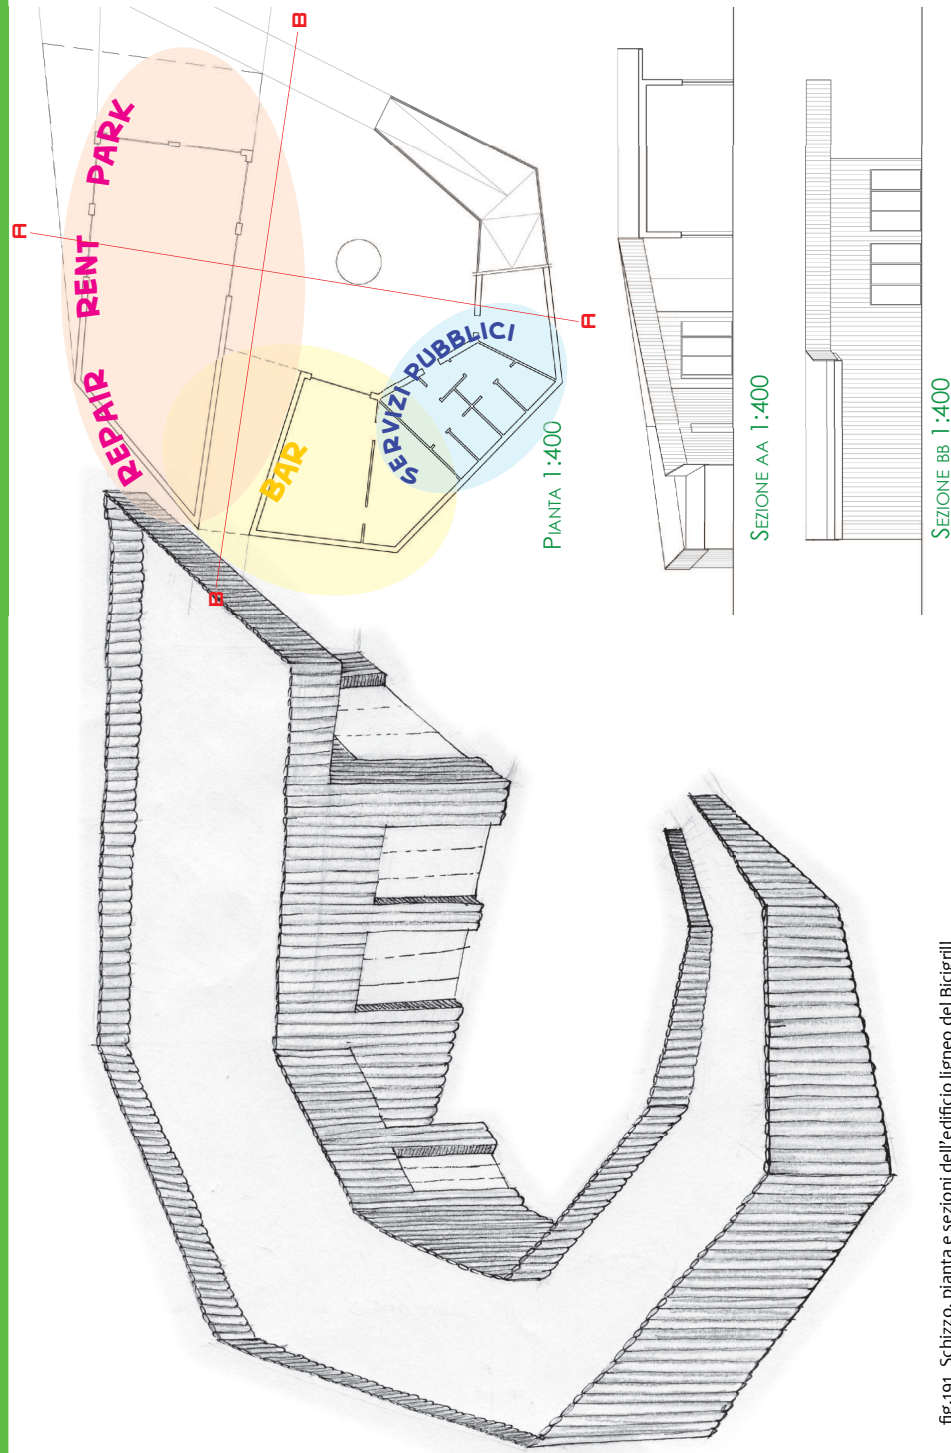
\_Schizzo, pianta e sezioni dell'edificio ligneo del Bicigrill
